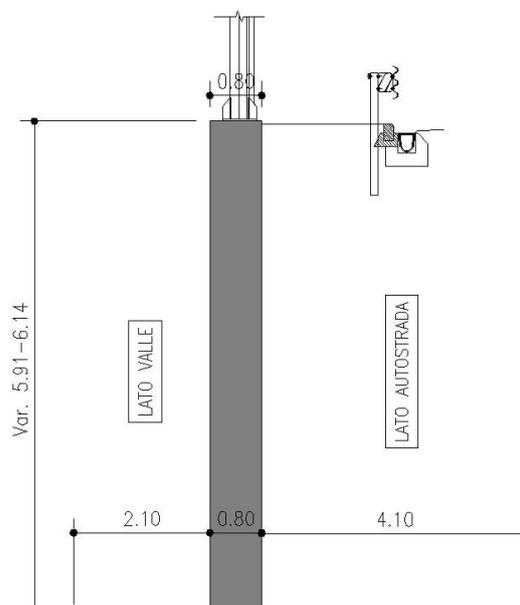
Sezione trasversale del muro andatore lato Rimini
